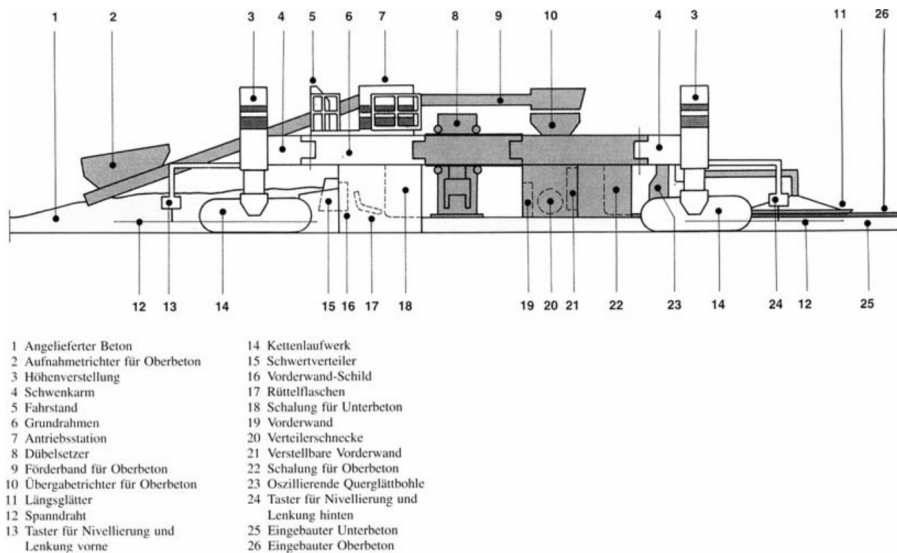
Schema eines Betondeckenfertigers für zweilagigen Einbau<sup>62</sup>
